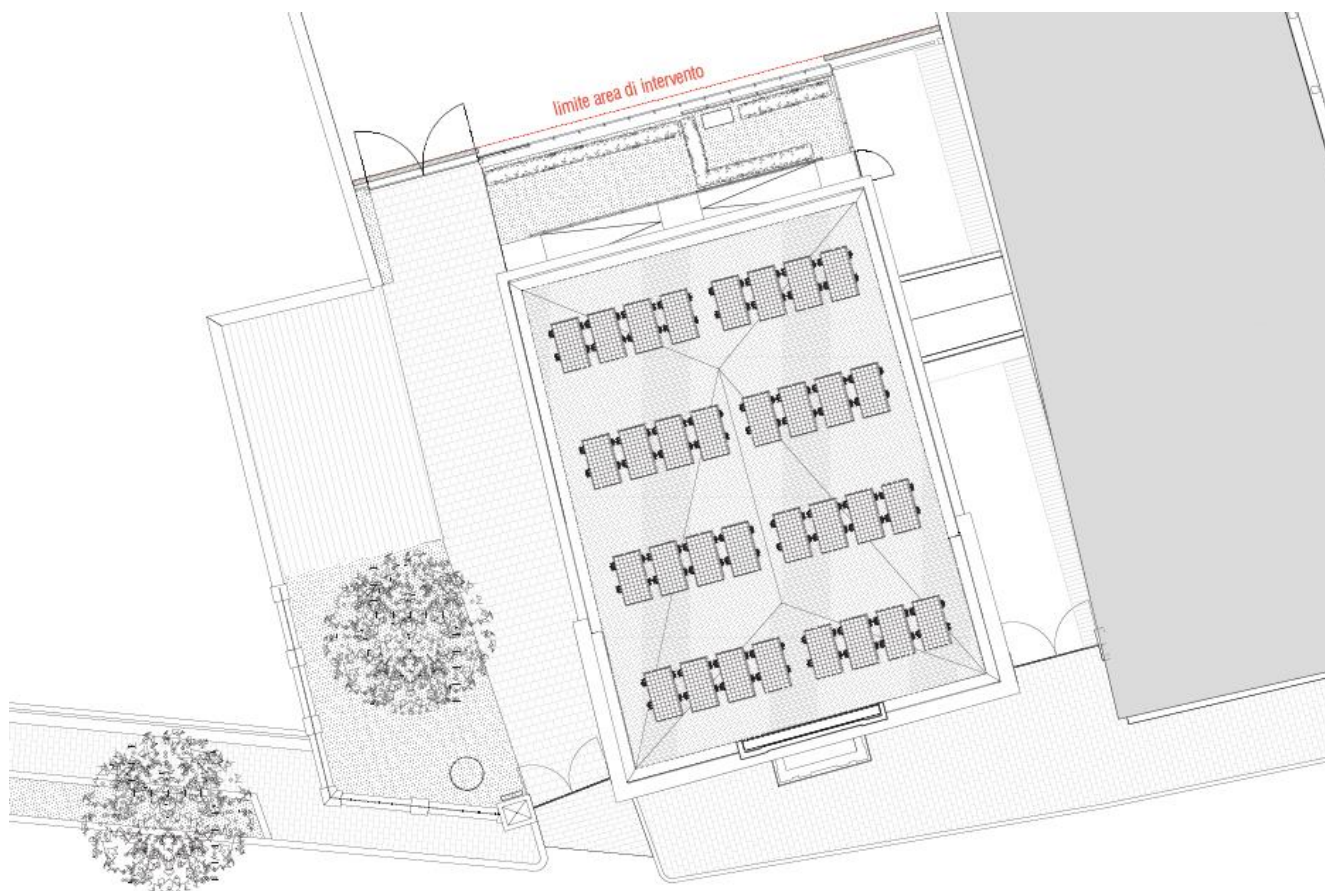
Estratto planimetria di progetto complesso Caserma Reginato.
